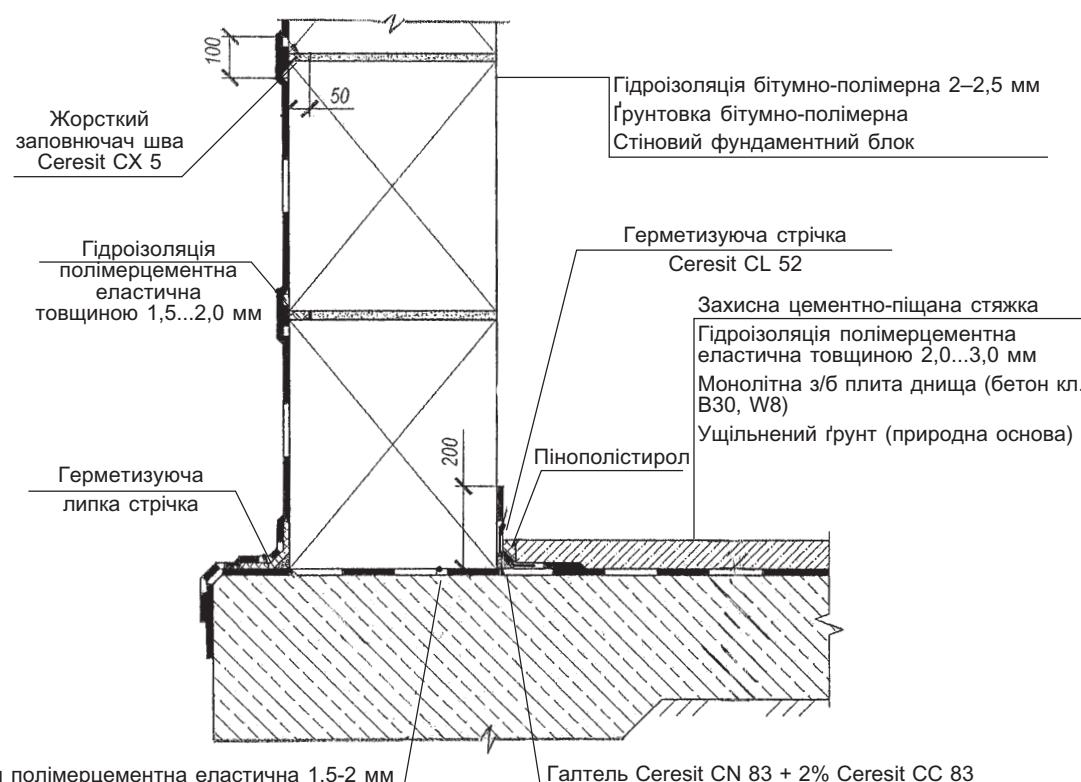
Гідроізоляція фундаменту та стін підвалу від ґрунтової вологи, що не підлягають наступній обробці
